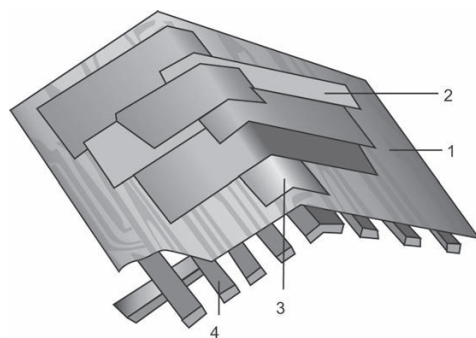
Обрешетка под рубероидную кровлю: 1 — защитный настил; 2 — рубероид; 3 — кровельная сталь; 4 — обрешетка
